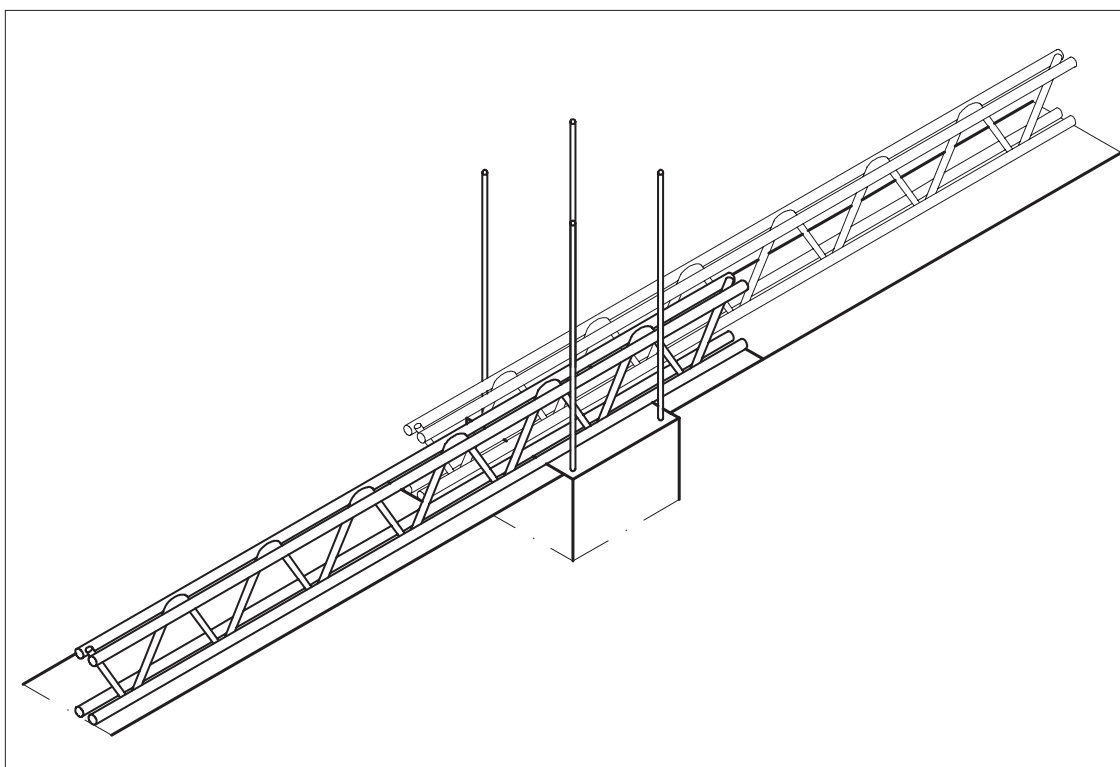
Travi piane con traliccio preformato disassato saldato al fondello in acciaio.
